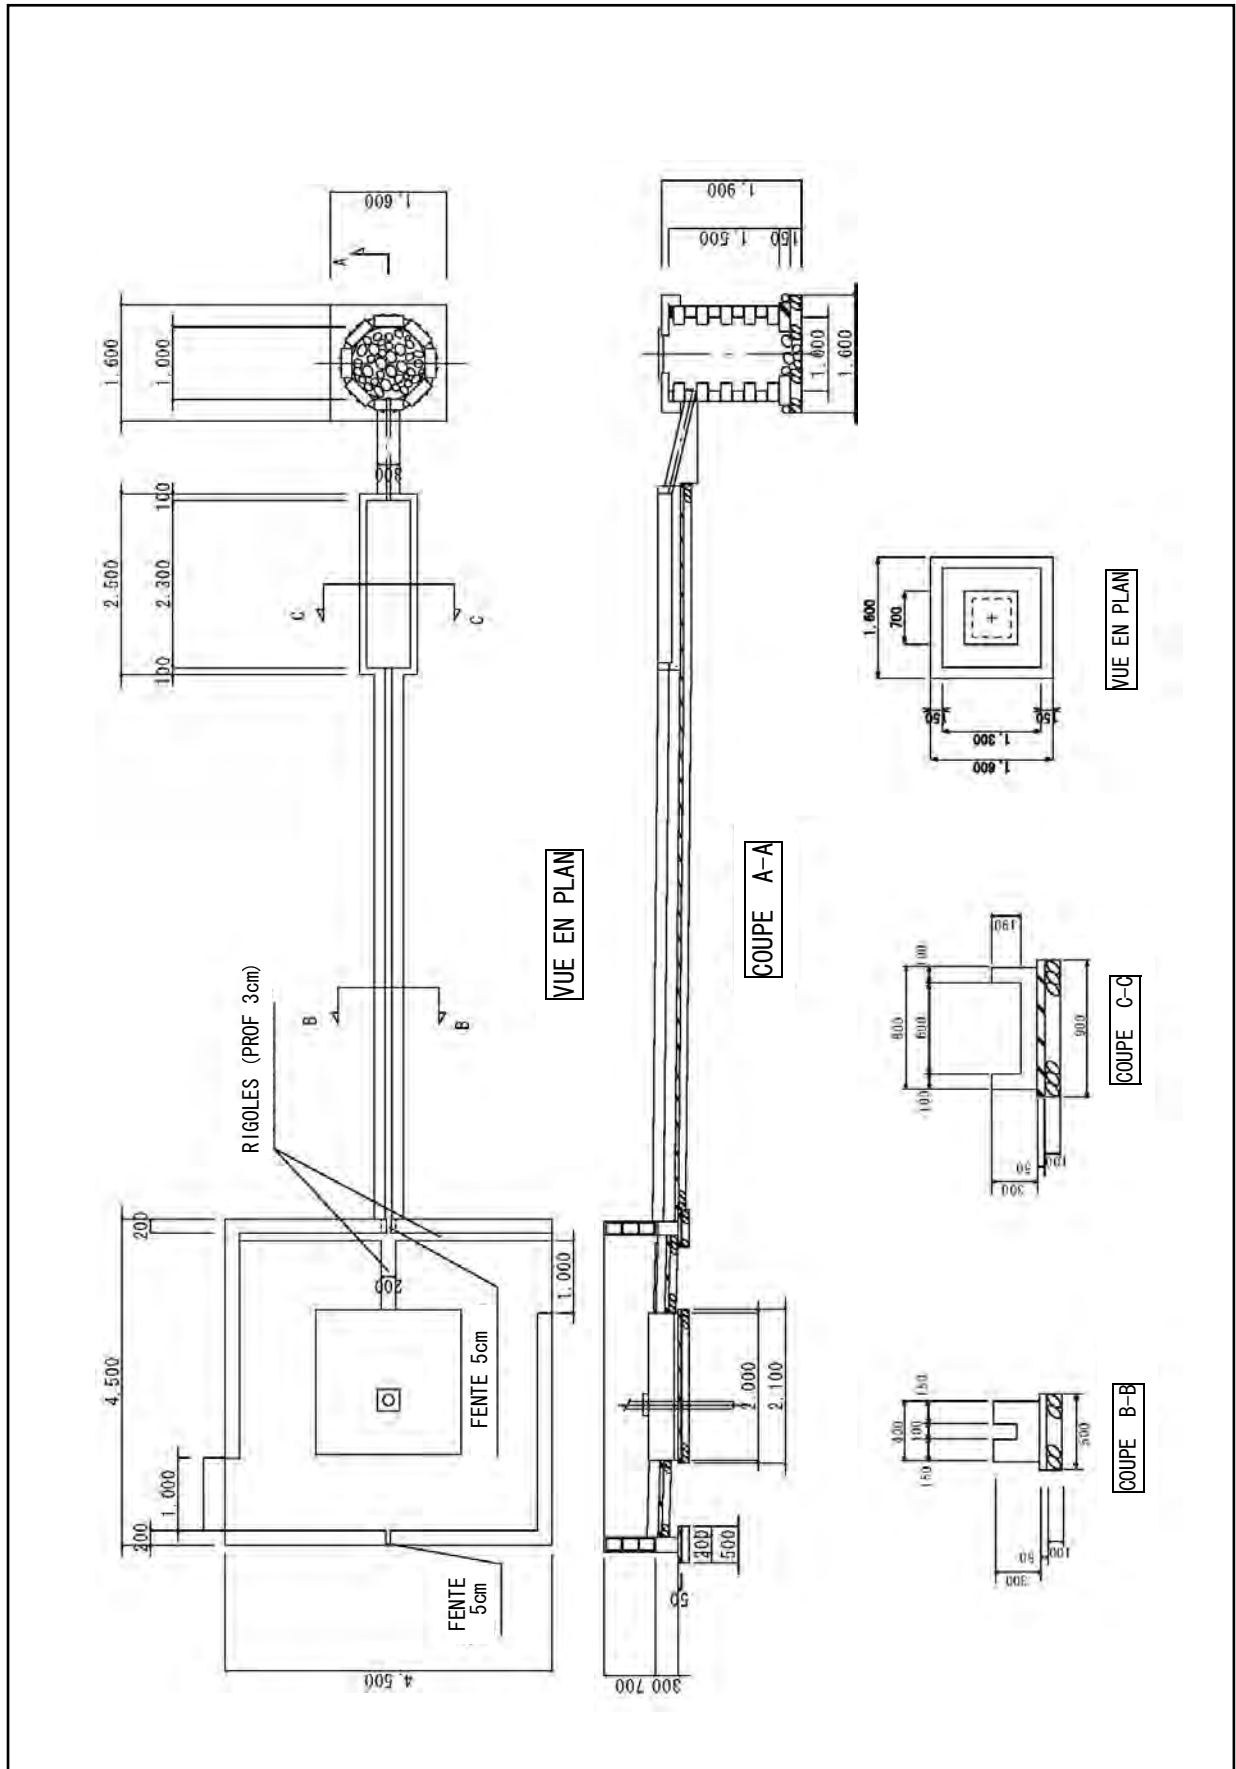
Plan de la superstructure du forage équipé d'une PMH
